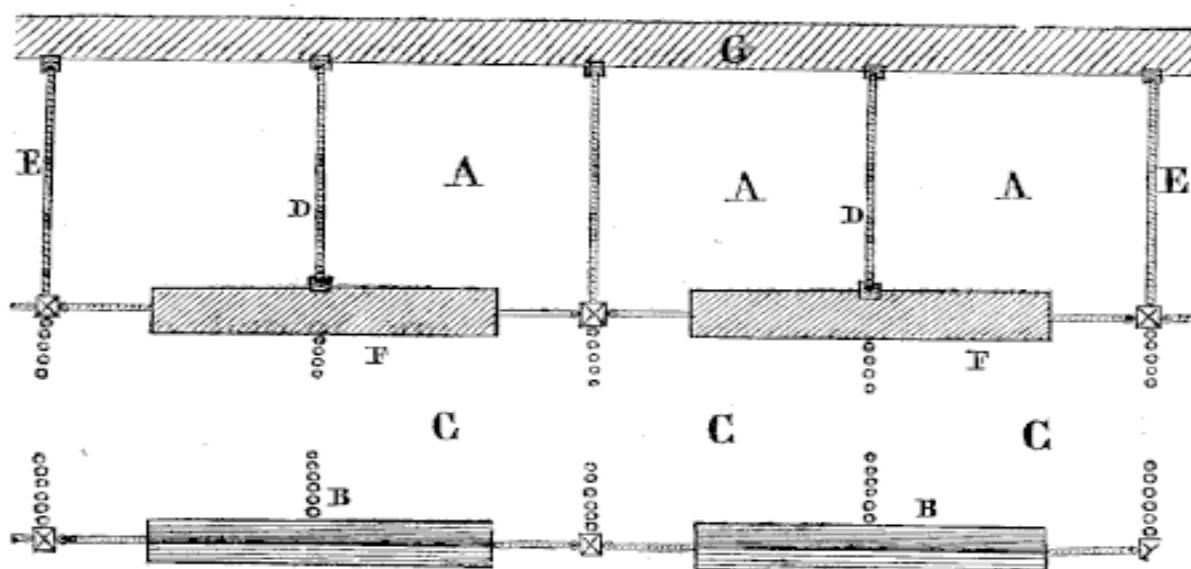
Plan d'un toit à pores avec cours en avant. Les auges dans la cour.
